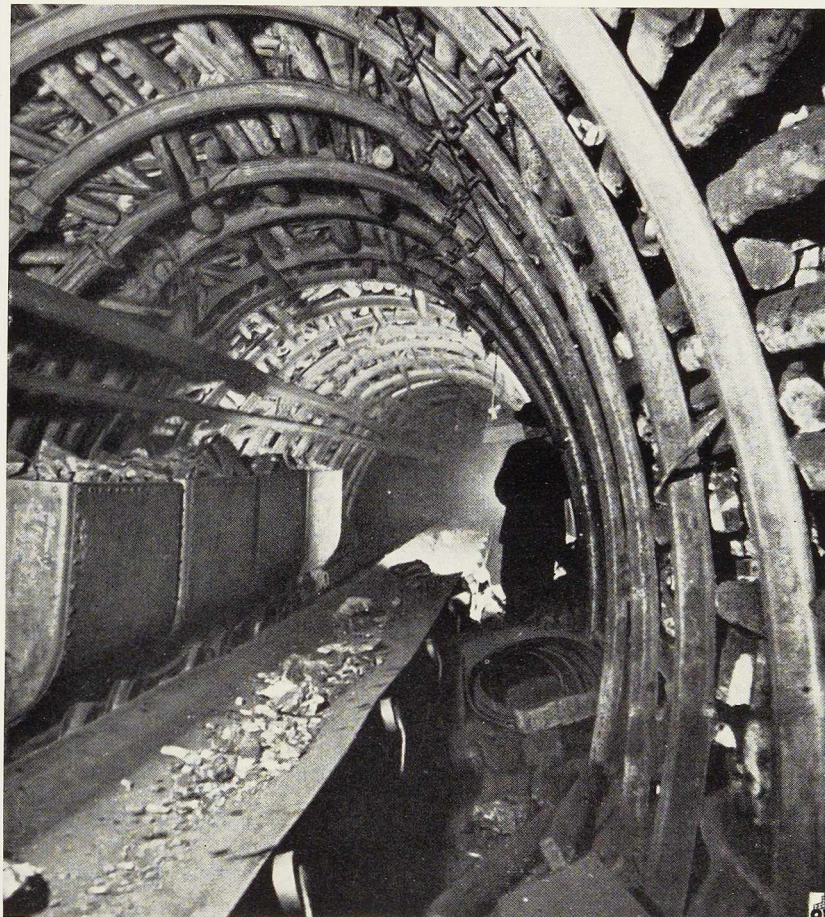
Galerie équipée du soutènement T. H. Cockerill.
